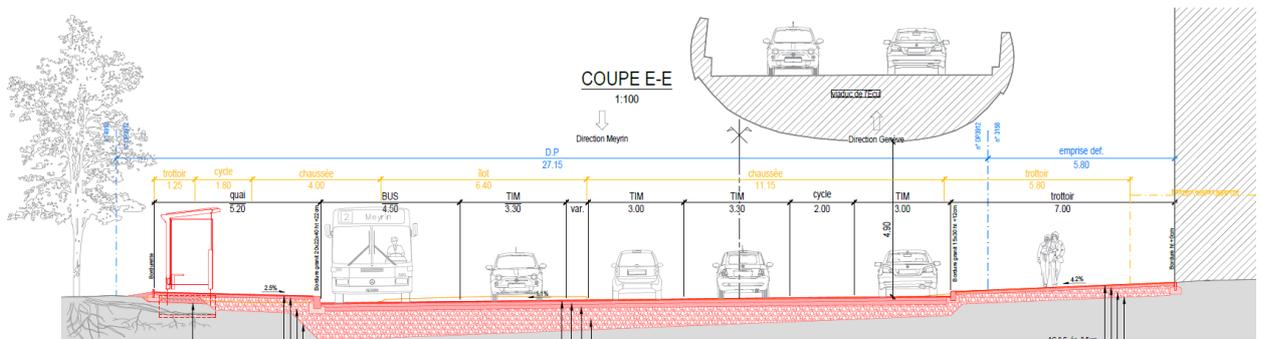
Coupe sur l'avenue de l'Ain au droit du futur centre culturel
